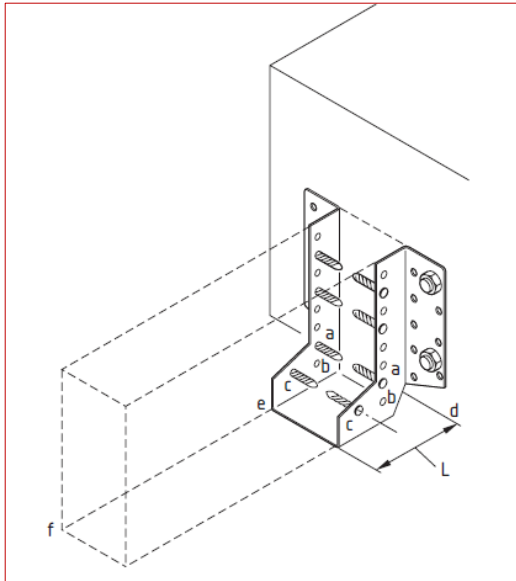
Exemple de bride pour relier le plancher au mur
